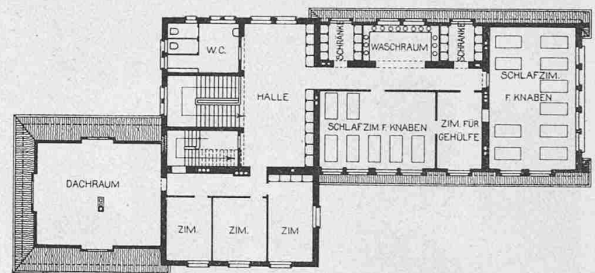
bis 5. Grundrisse vom Erdgeschoss, Keller, I. Stock und Dachstock. — 1 : 500.
